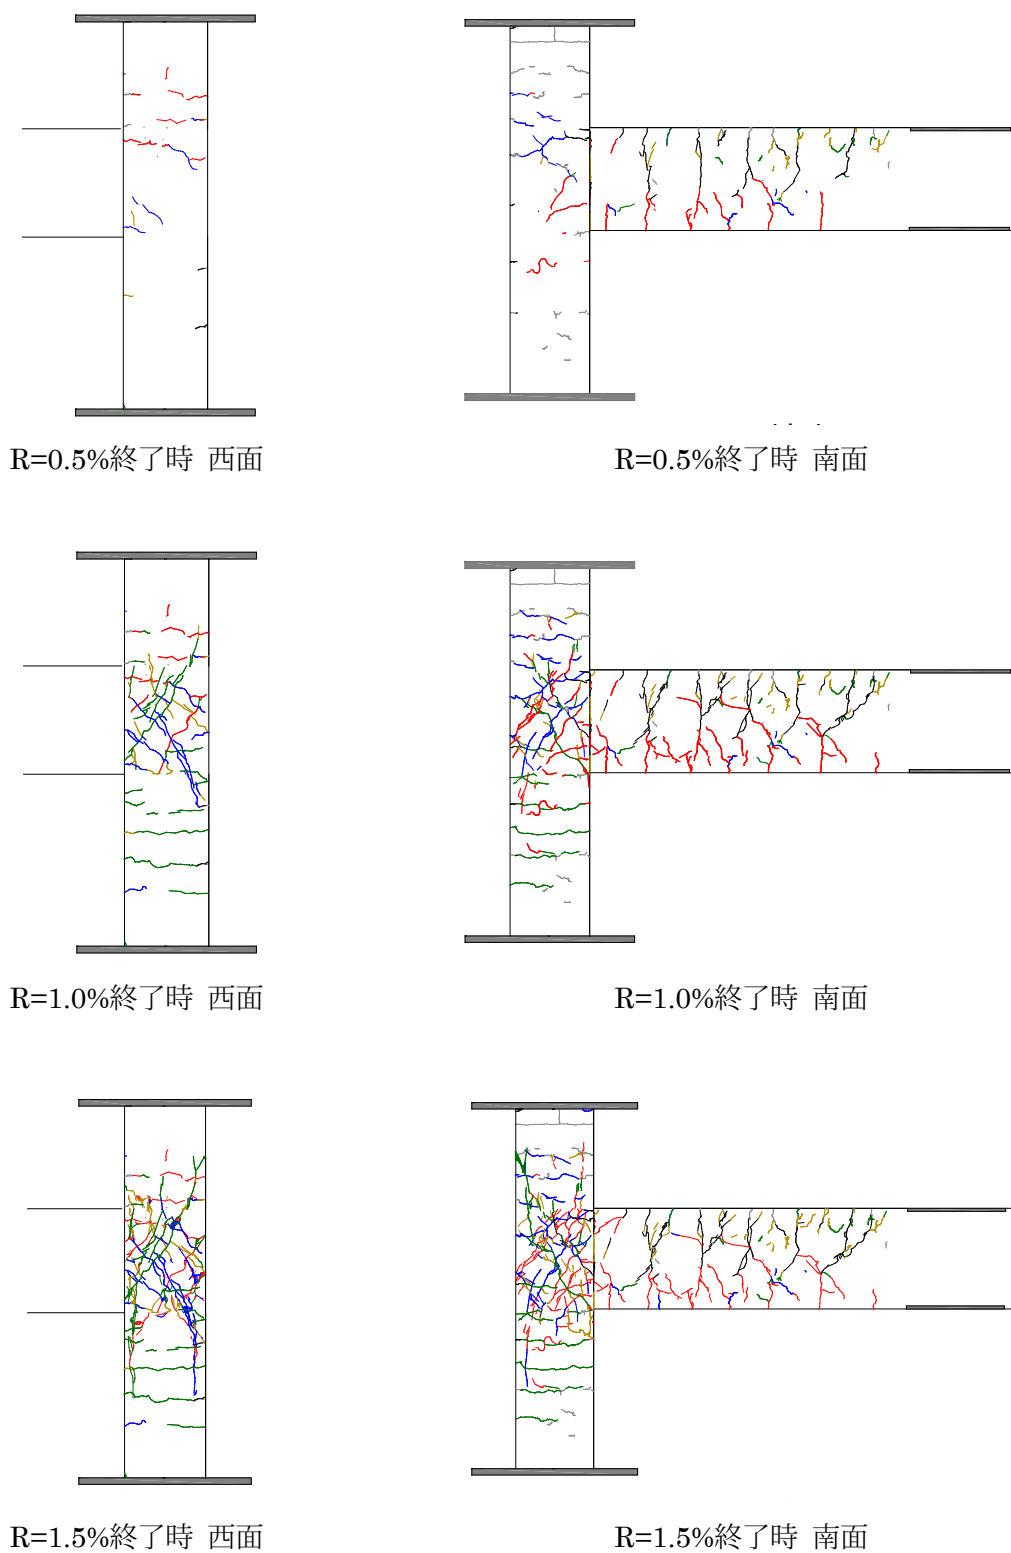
(b) ひび割れ状況 (試験体 F2)
